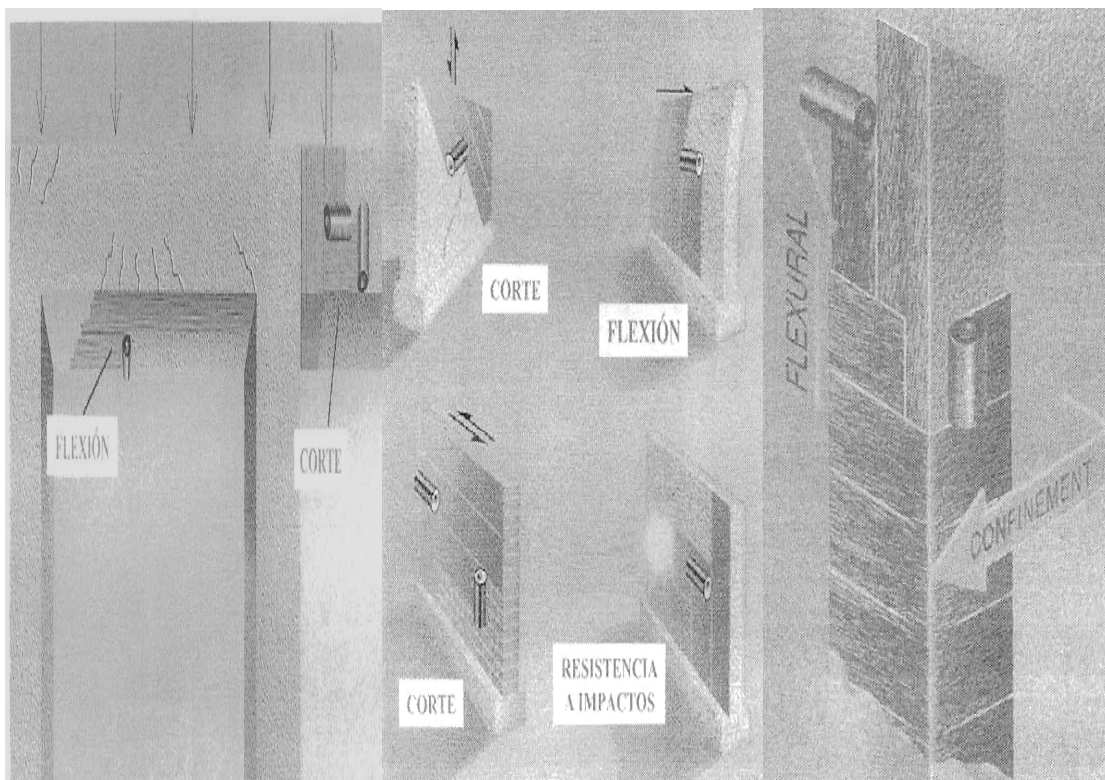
Refuerzos de fibra de carbono, según el tipo de carga que se ejerce a estructuras de concreto reforzado y muros de mampostería.
